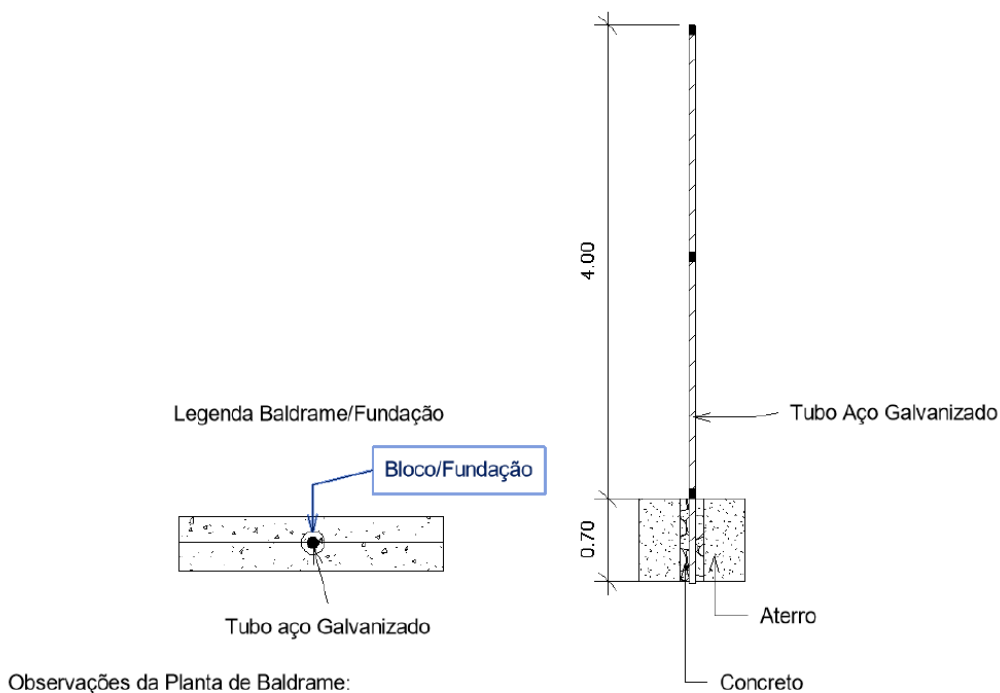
Detalhamento do baldrame – Adrian Wallace – Revit (2019).
